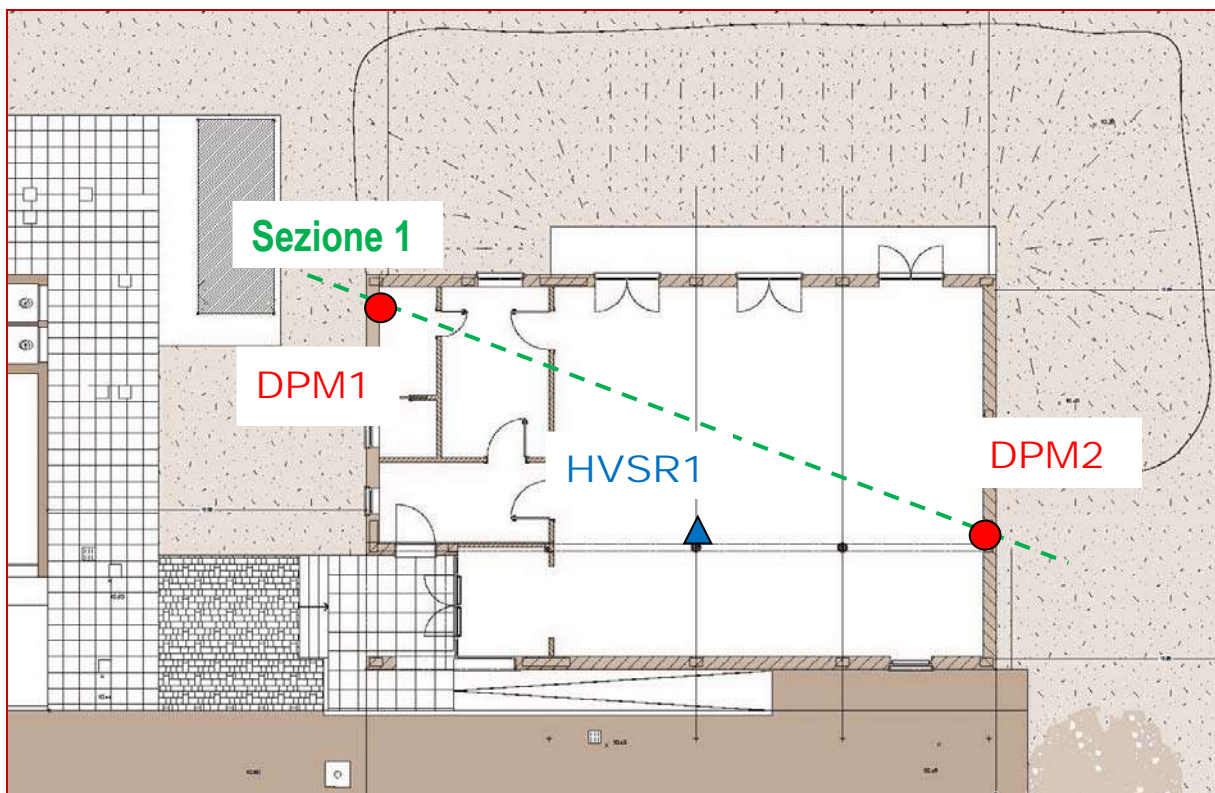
Planimetria con ubicazione prove e traccia sezione geologica interpretativa.
